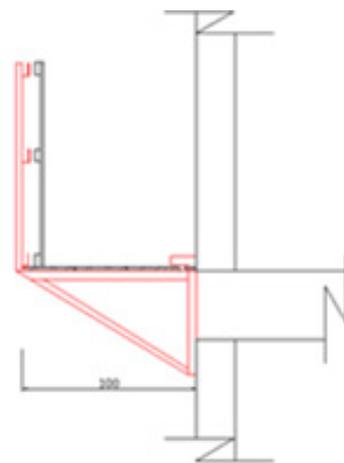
Vista Lateral de Guarda-Corpo em Pilar
